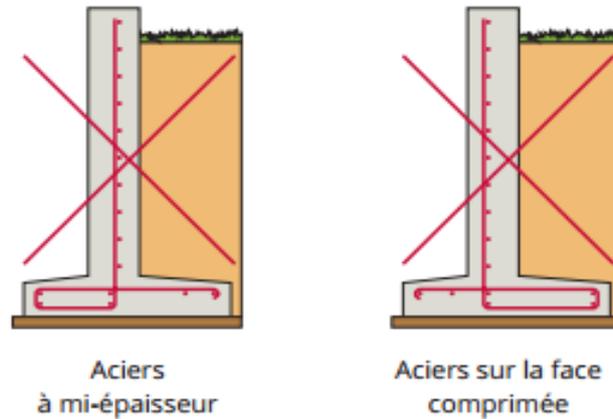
Emplacement déficientes à éviter de ferrailage d'un mur de soutènement.
